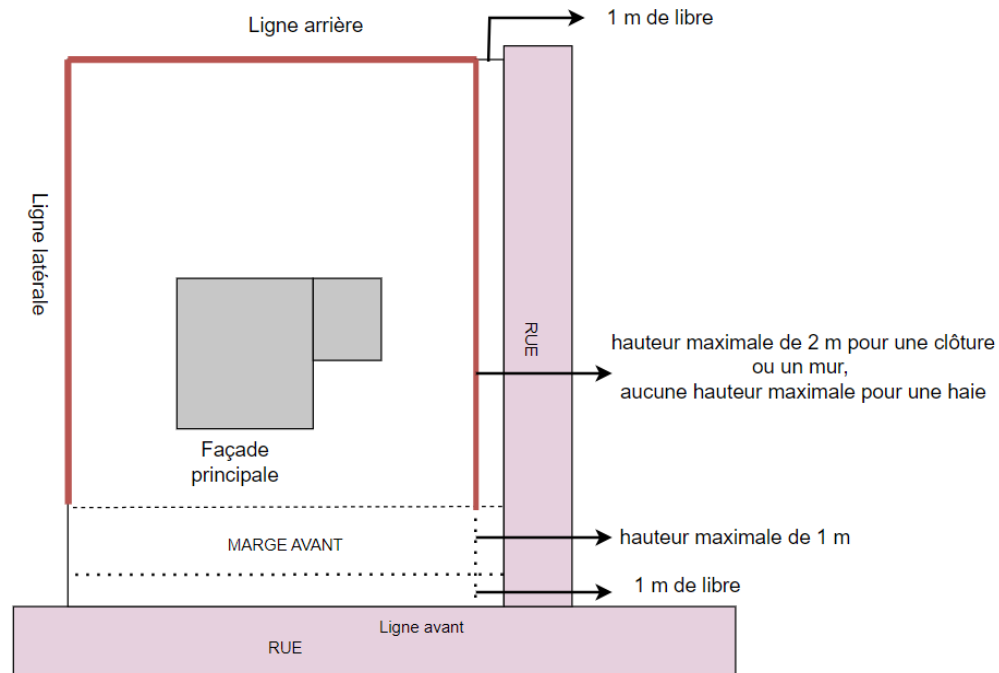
Hauteur d'une clôture, d'un mur ou d'une haie pour un terrain d'angle
